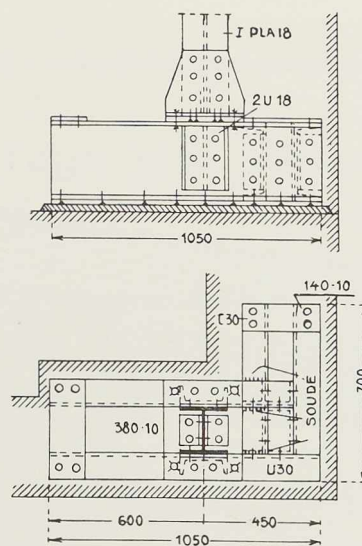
Fixation sur le béton d'une colonne située à un angle du bâtiment.
